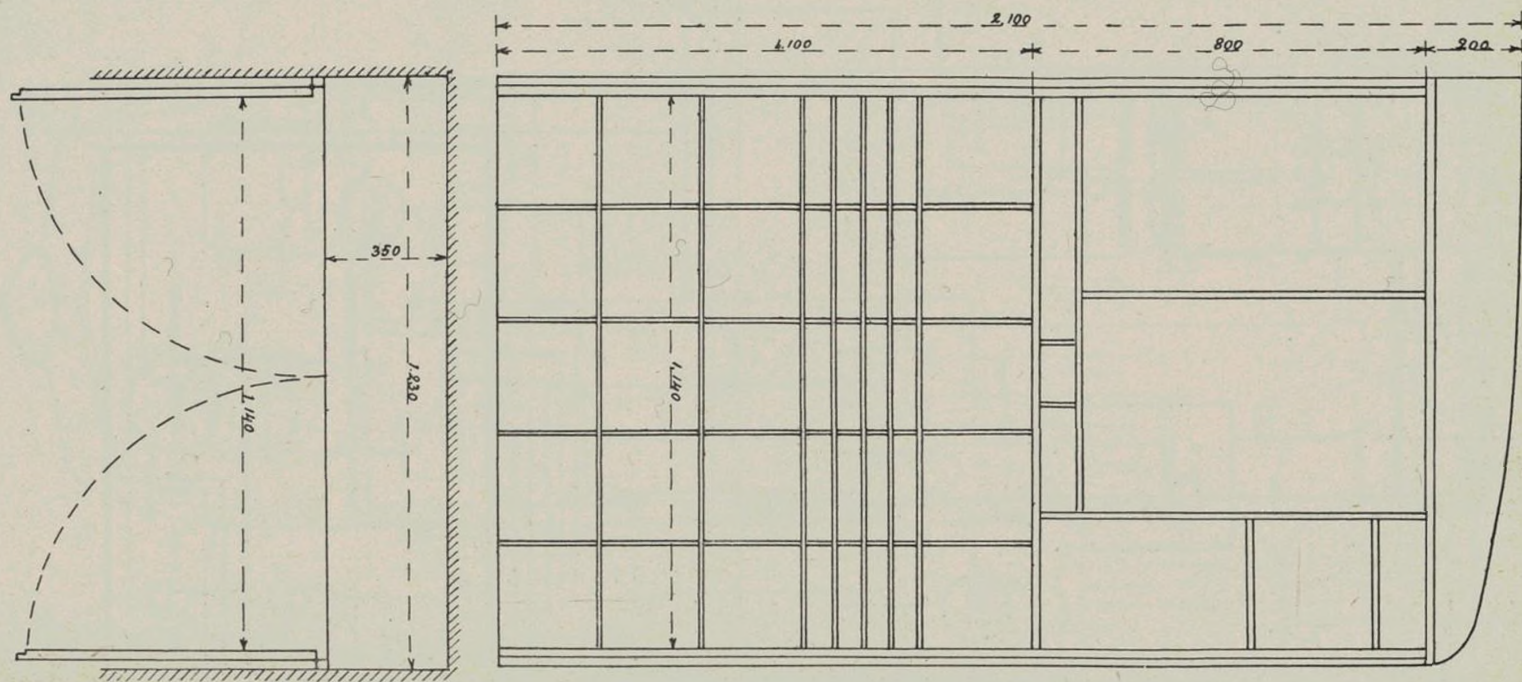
Plan du placard renfermant une partie d'appareils et de tests.
